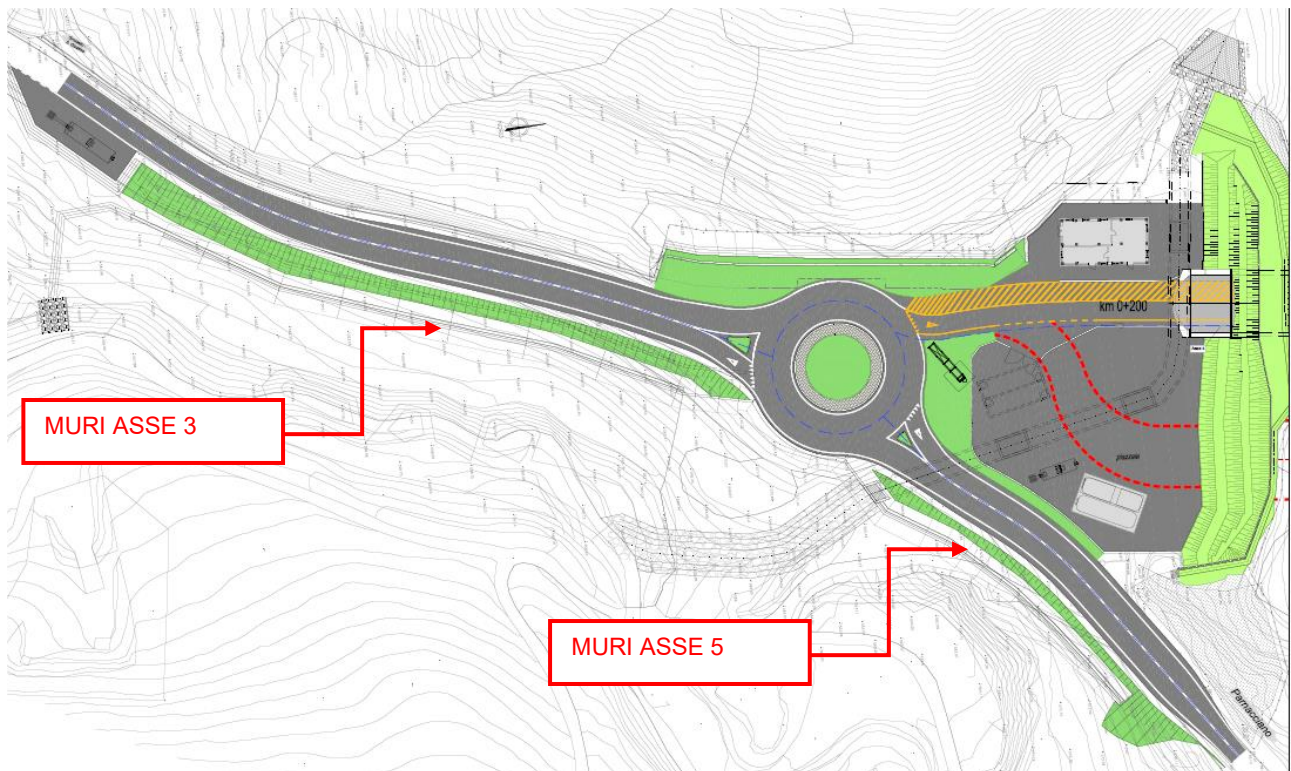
Stralcio planimetrico muri Asse 3 e Asse 5.
